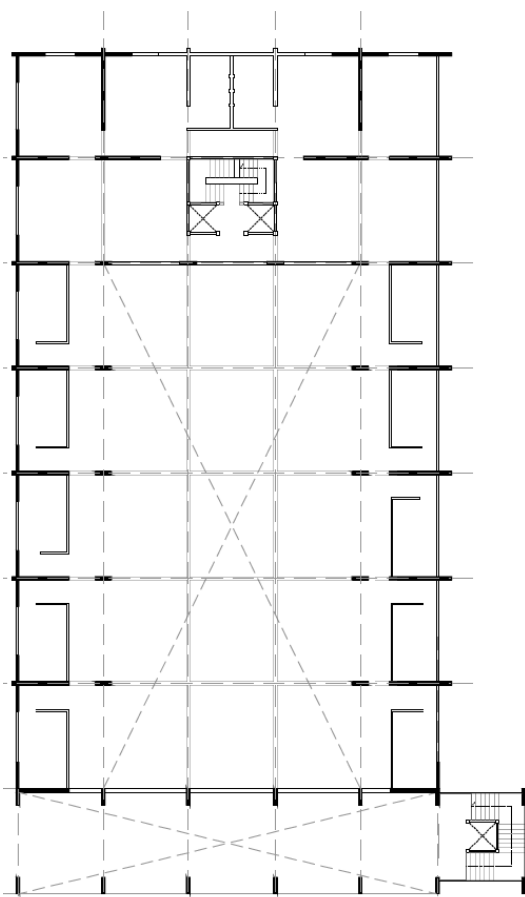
Planta do piso de consultas e fisioterapias do corpo largo do Centro
